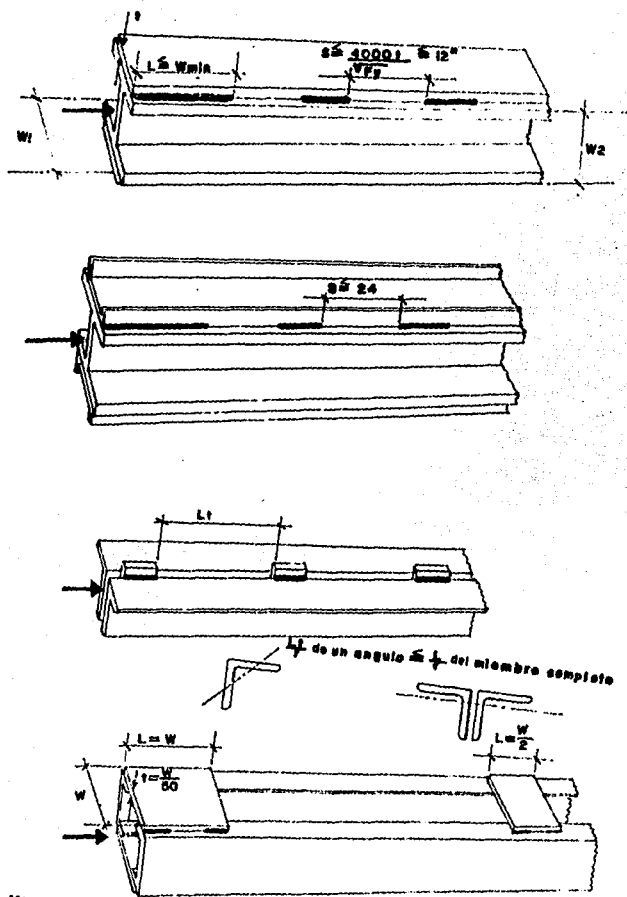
Elementos compuestos para contraventeos de compresión.
